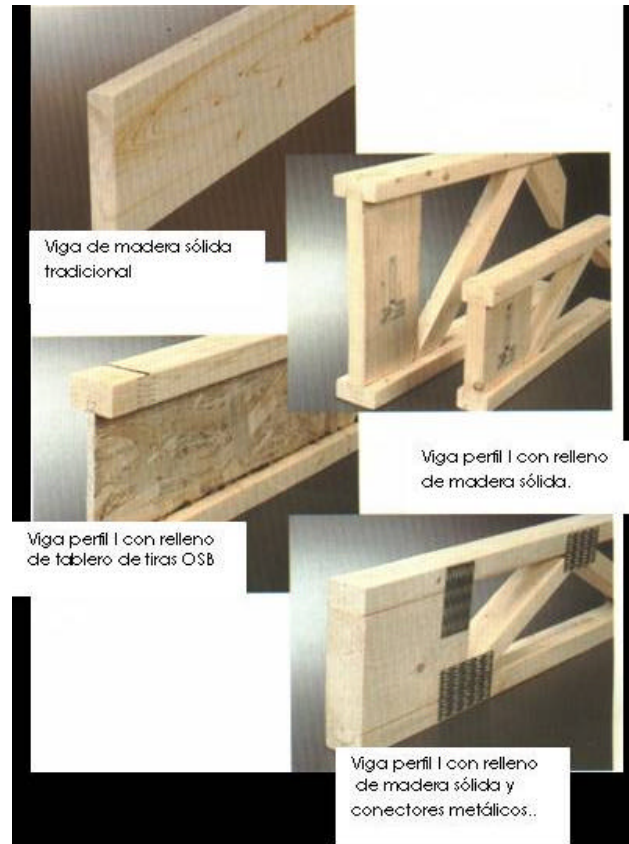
Vigas perfil I consideradas para el desarrollo de un producto innovador para la construcción. Fuente: Forintek Canadá Corp., 2002.
